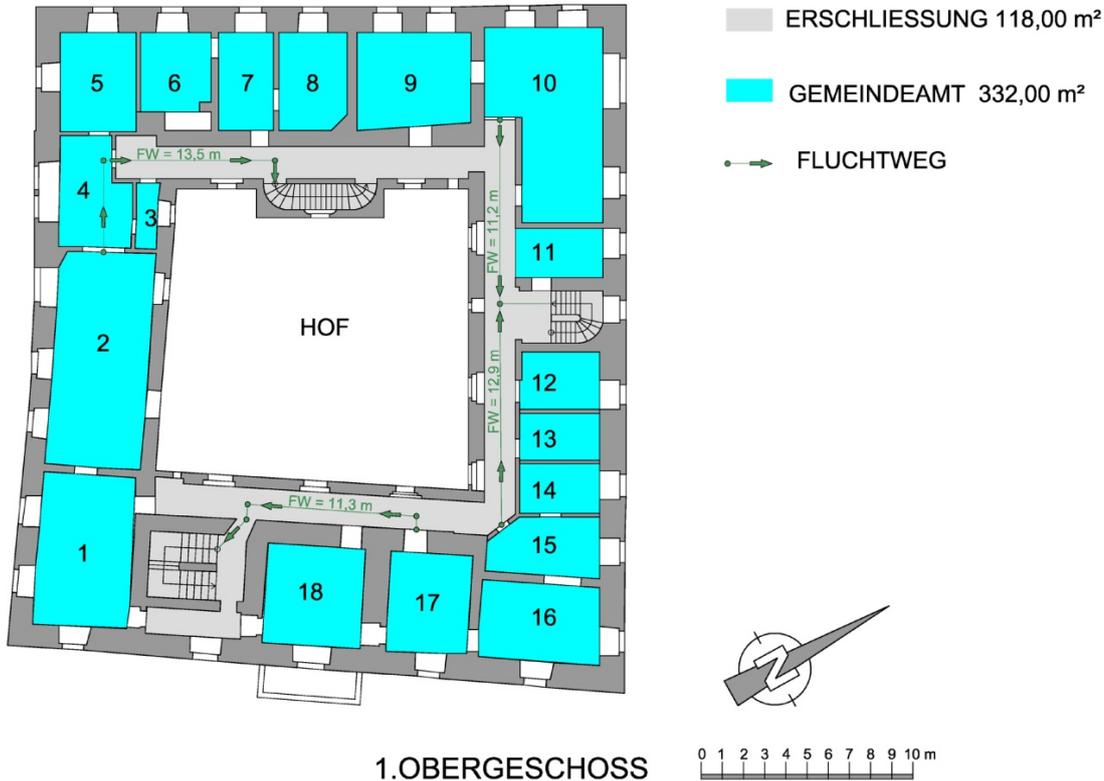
zeigt den Grundriss des Schlosses Dürnkrot
